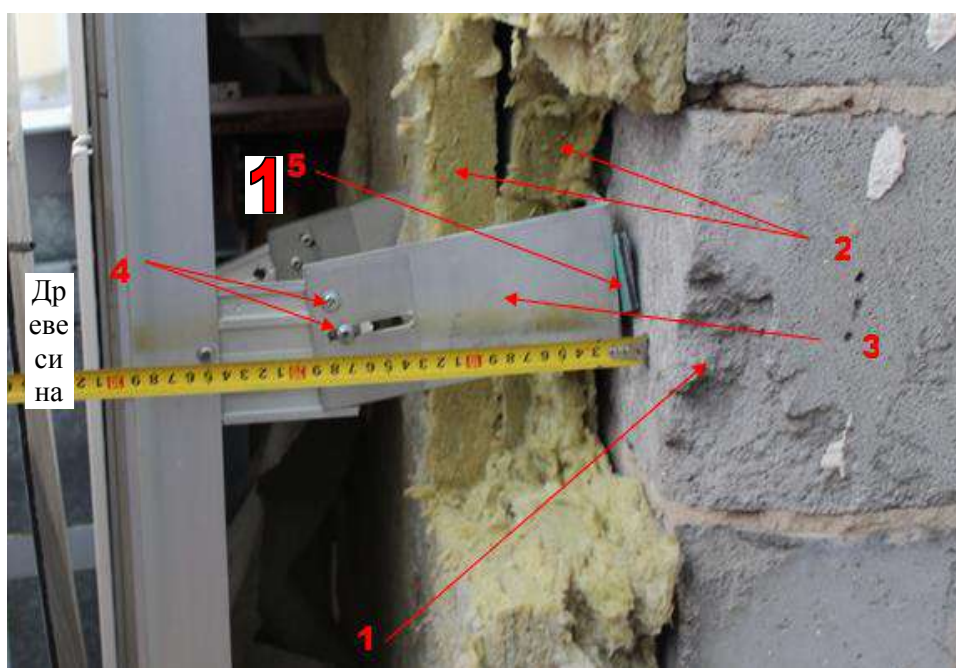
Вид сверху на элементы навесного, вентилируемого фасада поликлиники -5:
